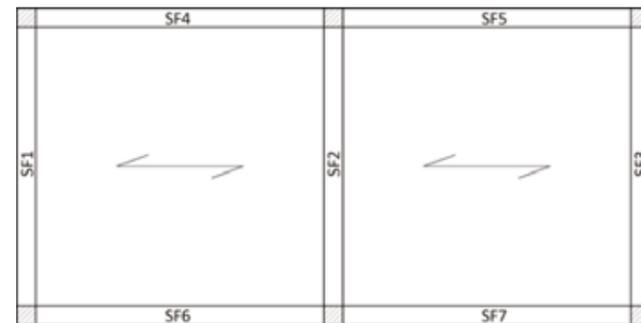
Schema elementare di impalcato costituito da 7 travi di tipo SlimFloor
